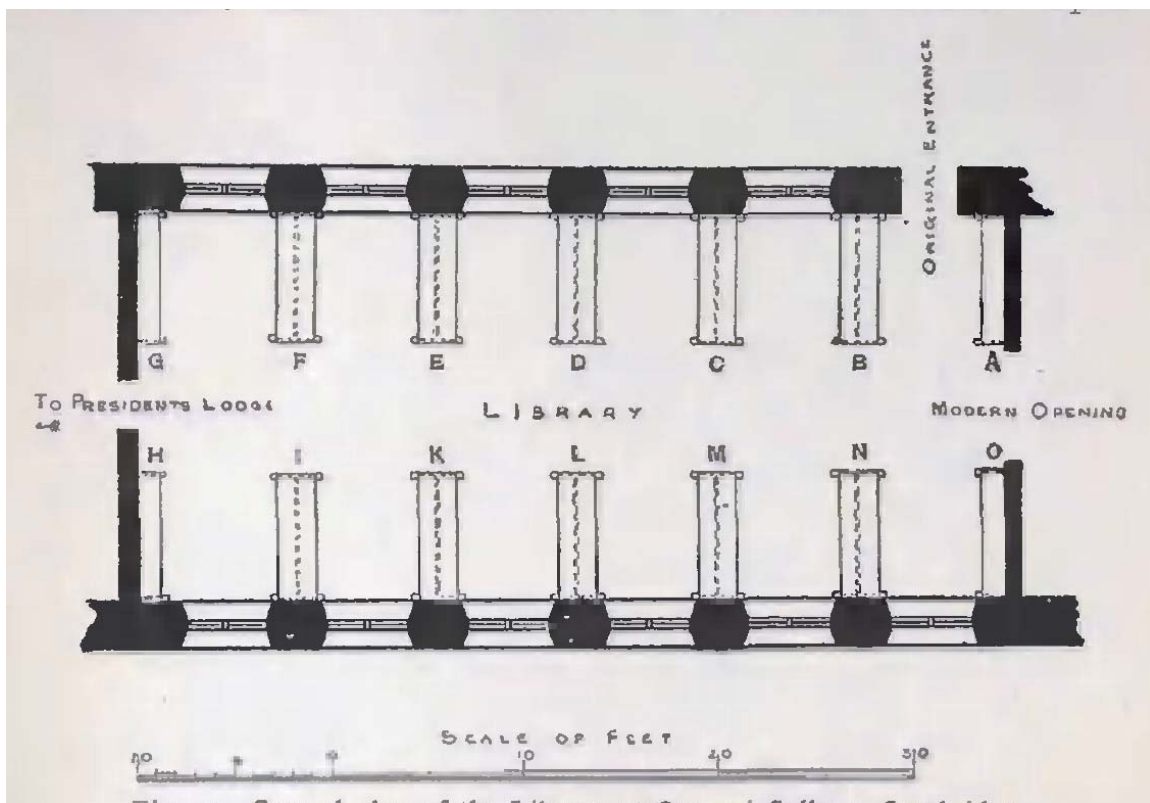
Reconstitution du plan de la bibliothèque du Queen's College, Cambridge, par J.W. Clark
